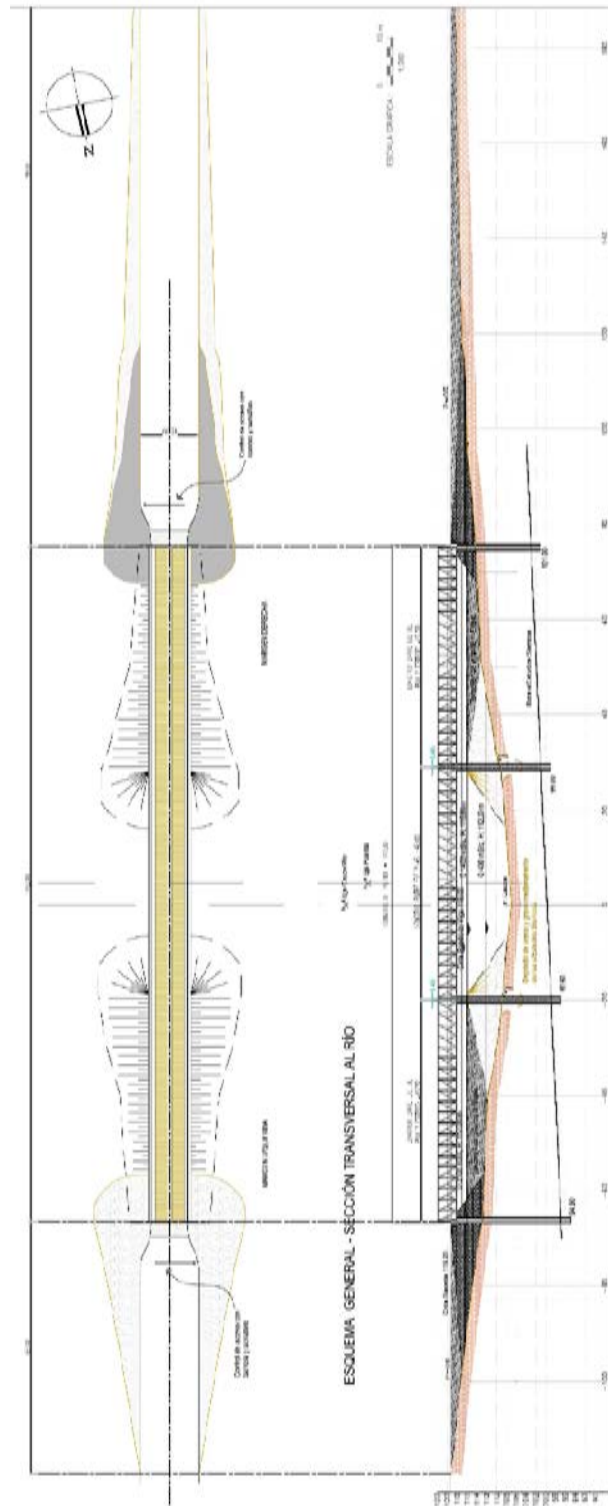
Planta y vista general del puente de servicio en NK (Fuente: Elaboración propia)
